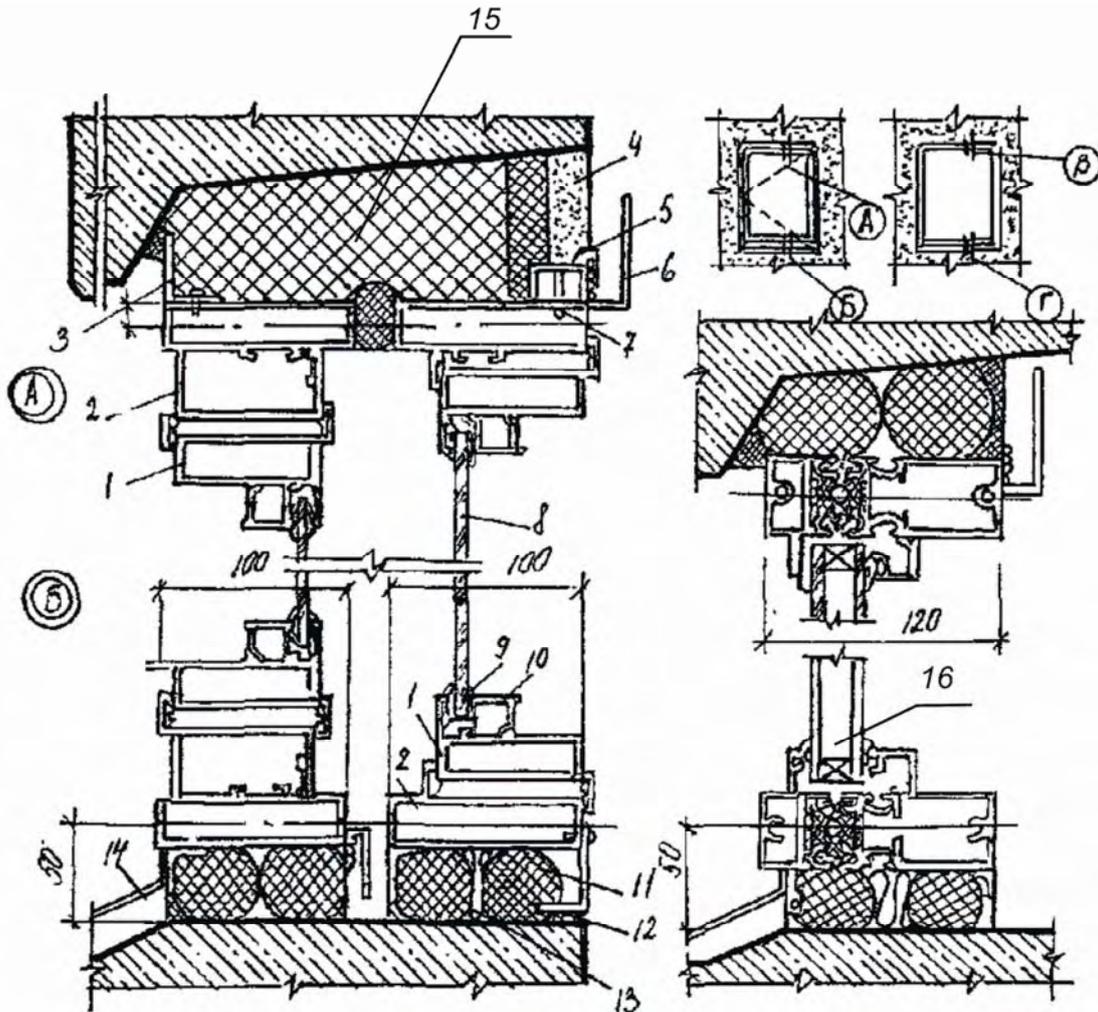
Окна с алюминиевыми переплетами: 1 — переплет створки; 2 — коробка; 3 — утеплитель; 4 — штукатурка; 5 — стальная пружина; 6 — нащельник; 7 — самонарезающий винт; 8 — стекло; 9 — уплотнитель; 10 — штапик; 11 — эластичная прокладка; 12 — мастика; 13 — смоляная пакля; 14 — слив; 15 — термовкладыш; 16 — стеклопакет
